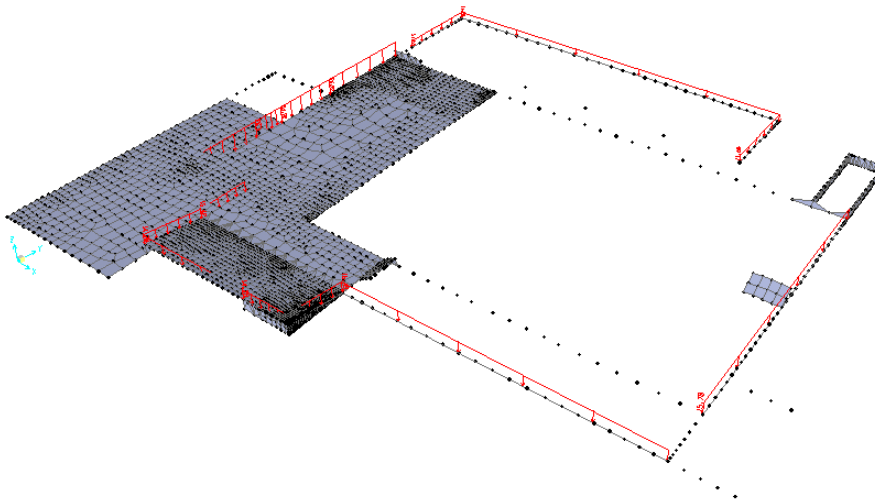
Cargas referentes às paredes de alvenaria exteriores aplicadas no piso 1
